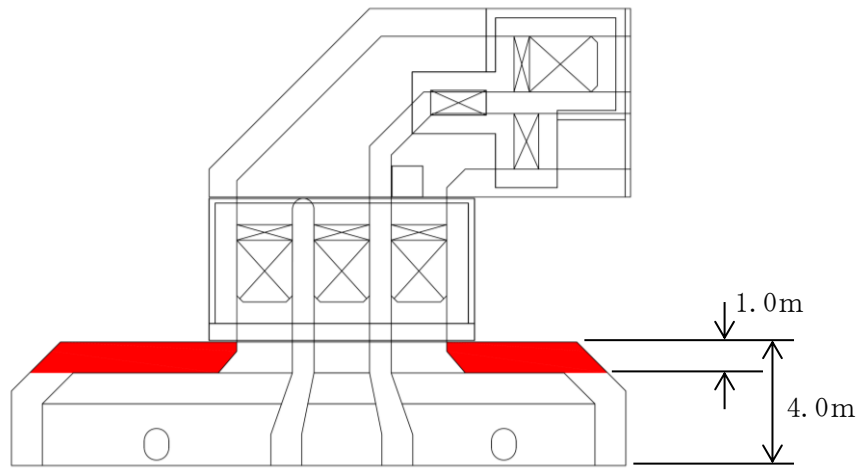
補機冷却用海水取水路の平面図 (A-A断面, 南側構造物拡大)
